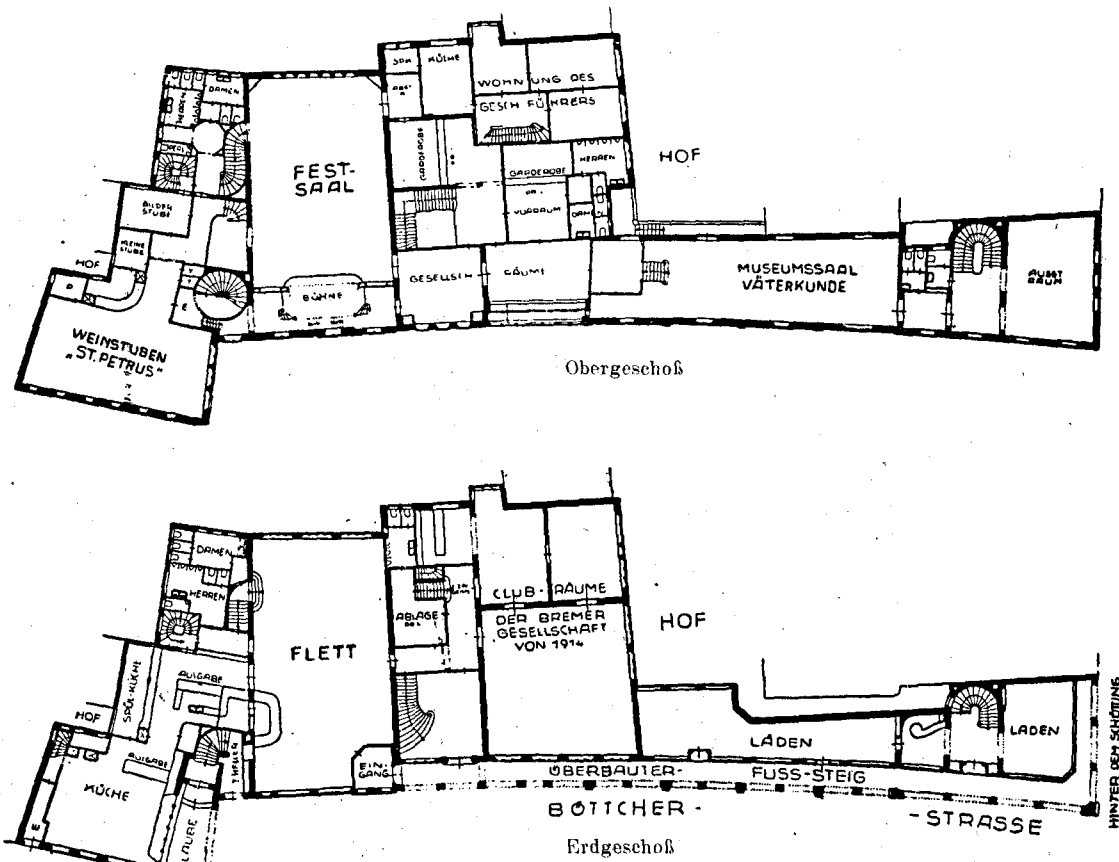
und 5 — Erdgeschoß- und Obergeschoßgrundriß das Hag-Hauses
